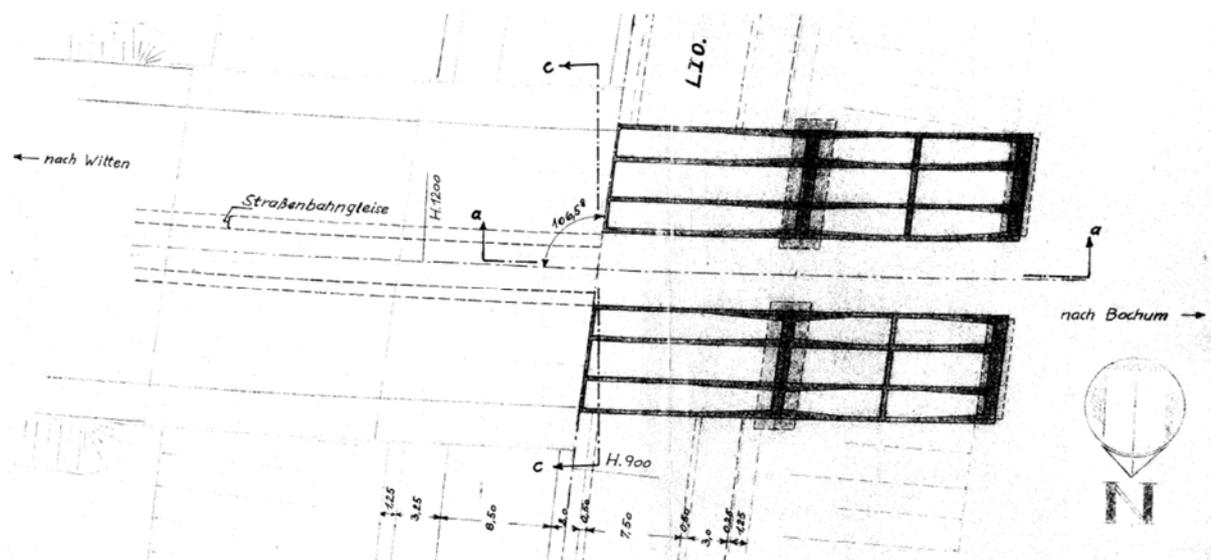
Draufsicht/Grundriss, BW 179, Wittener Straße
